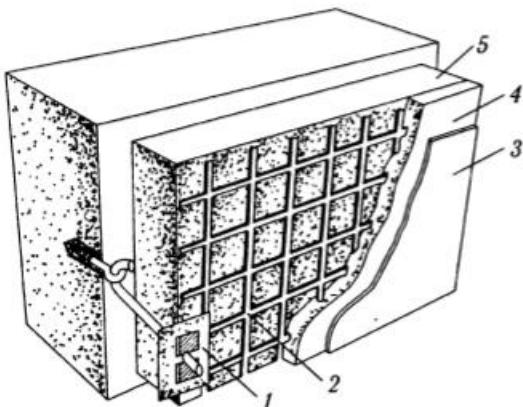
Обволікальна теплоізоляція фасаду:
